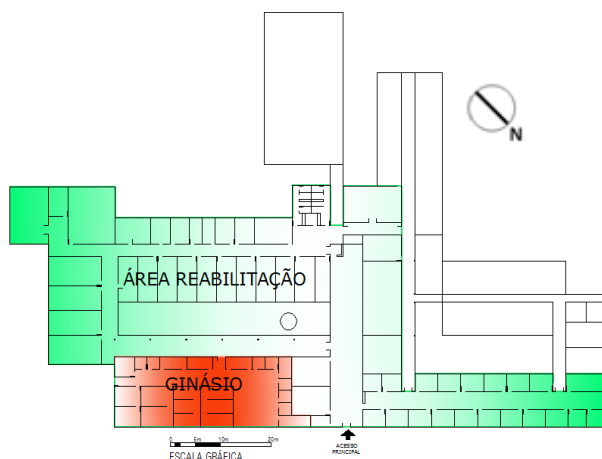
Planta baixa CRI-Natal (com ginásio de reabilitação e área de reabilitação em destaque)
